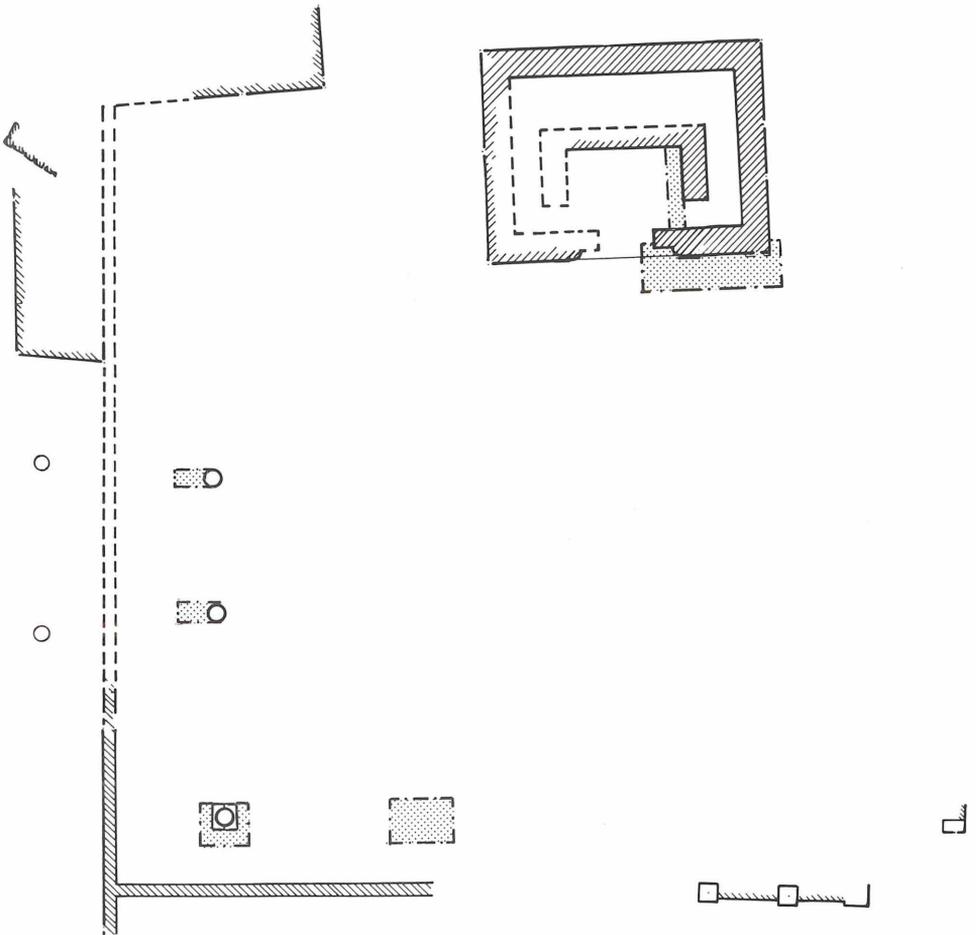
Sabra, Tempelterrasse, Schnittplan.
